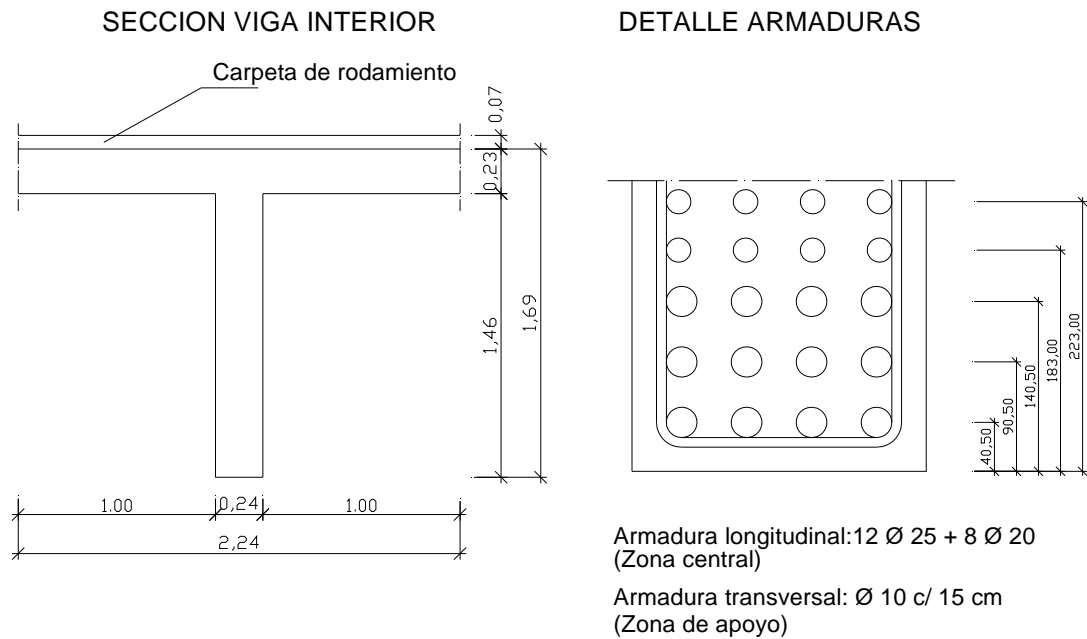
Dimensiones de la viga interior y detalle de armaduras.
